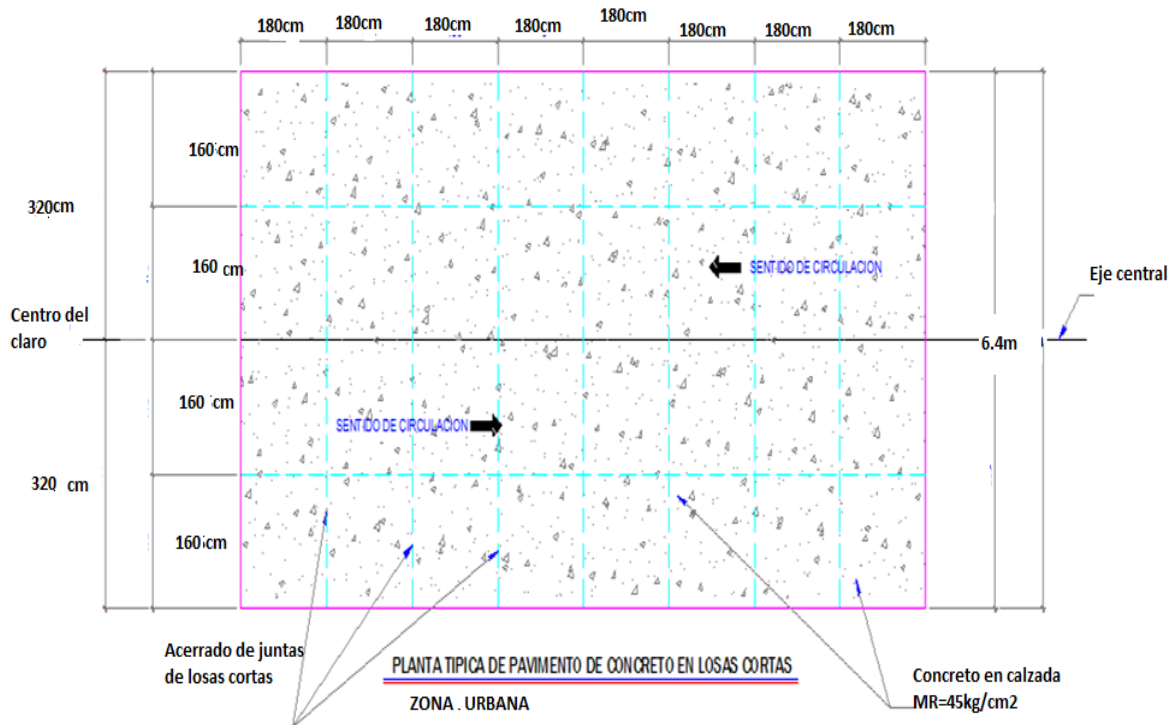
Planta típica de pavimento de concreto de losas cortas en zona urbana.
